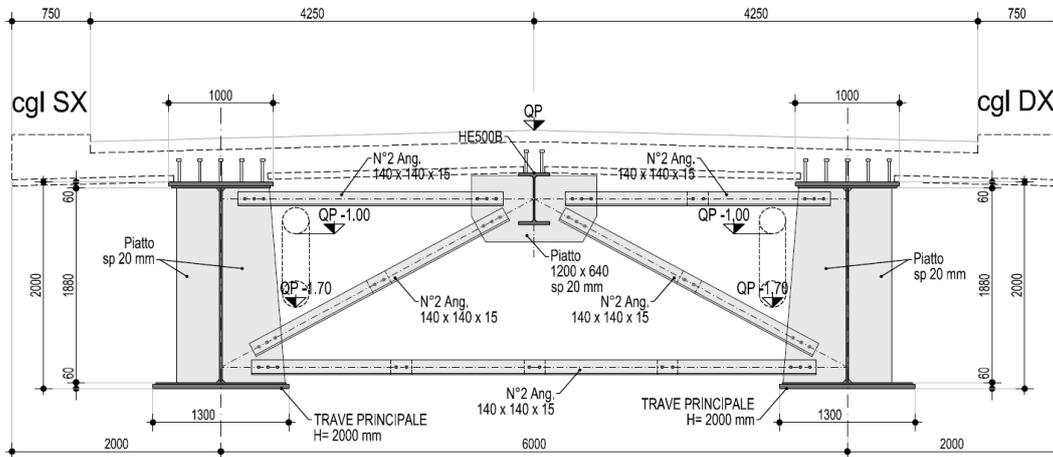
SEZIONE TRASVERSALE IMPALCATO IN CAMPATA 1
